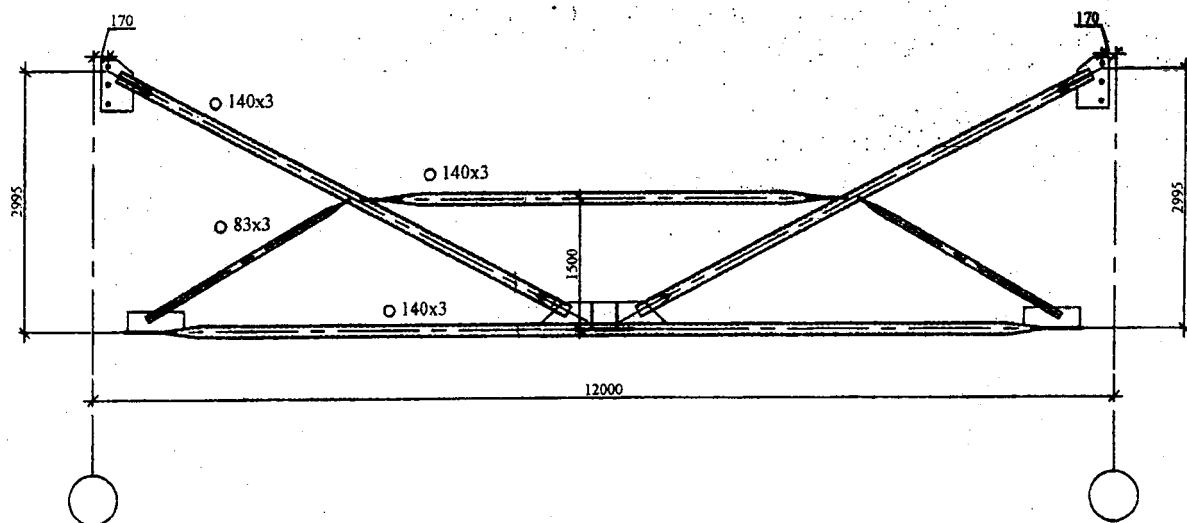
Конструктивное решение вертикальной связи из круглых труб при шаге ферм 12 м
